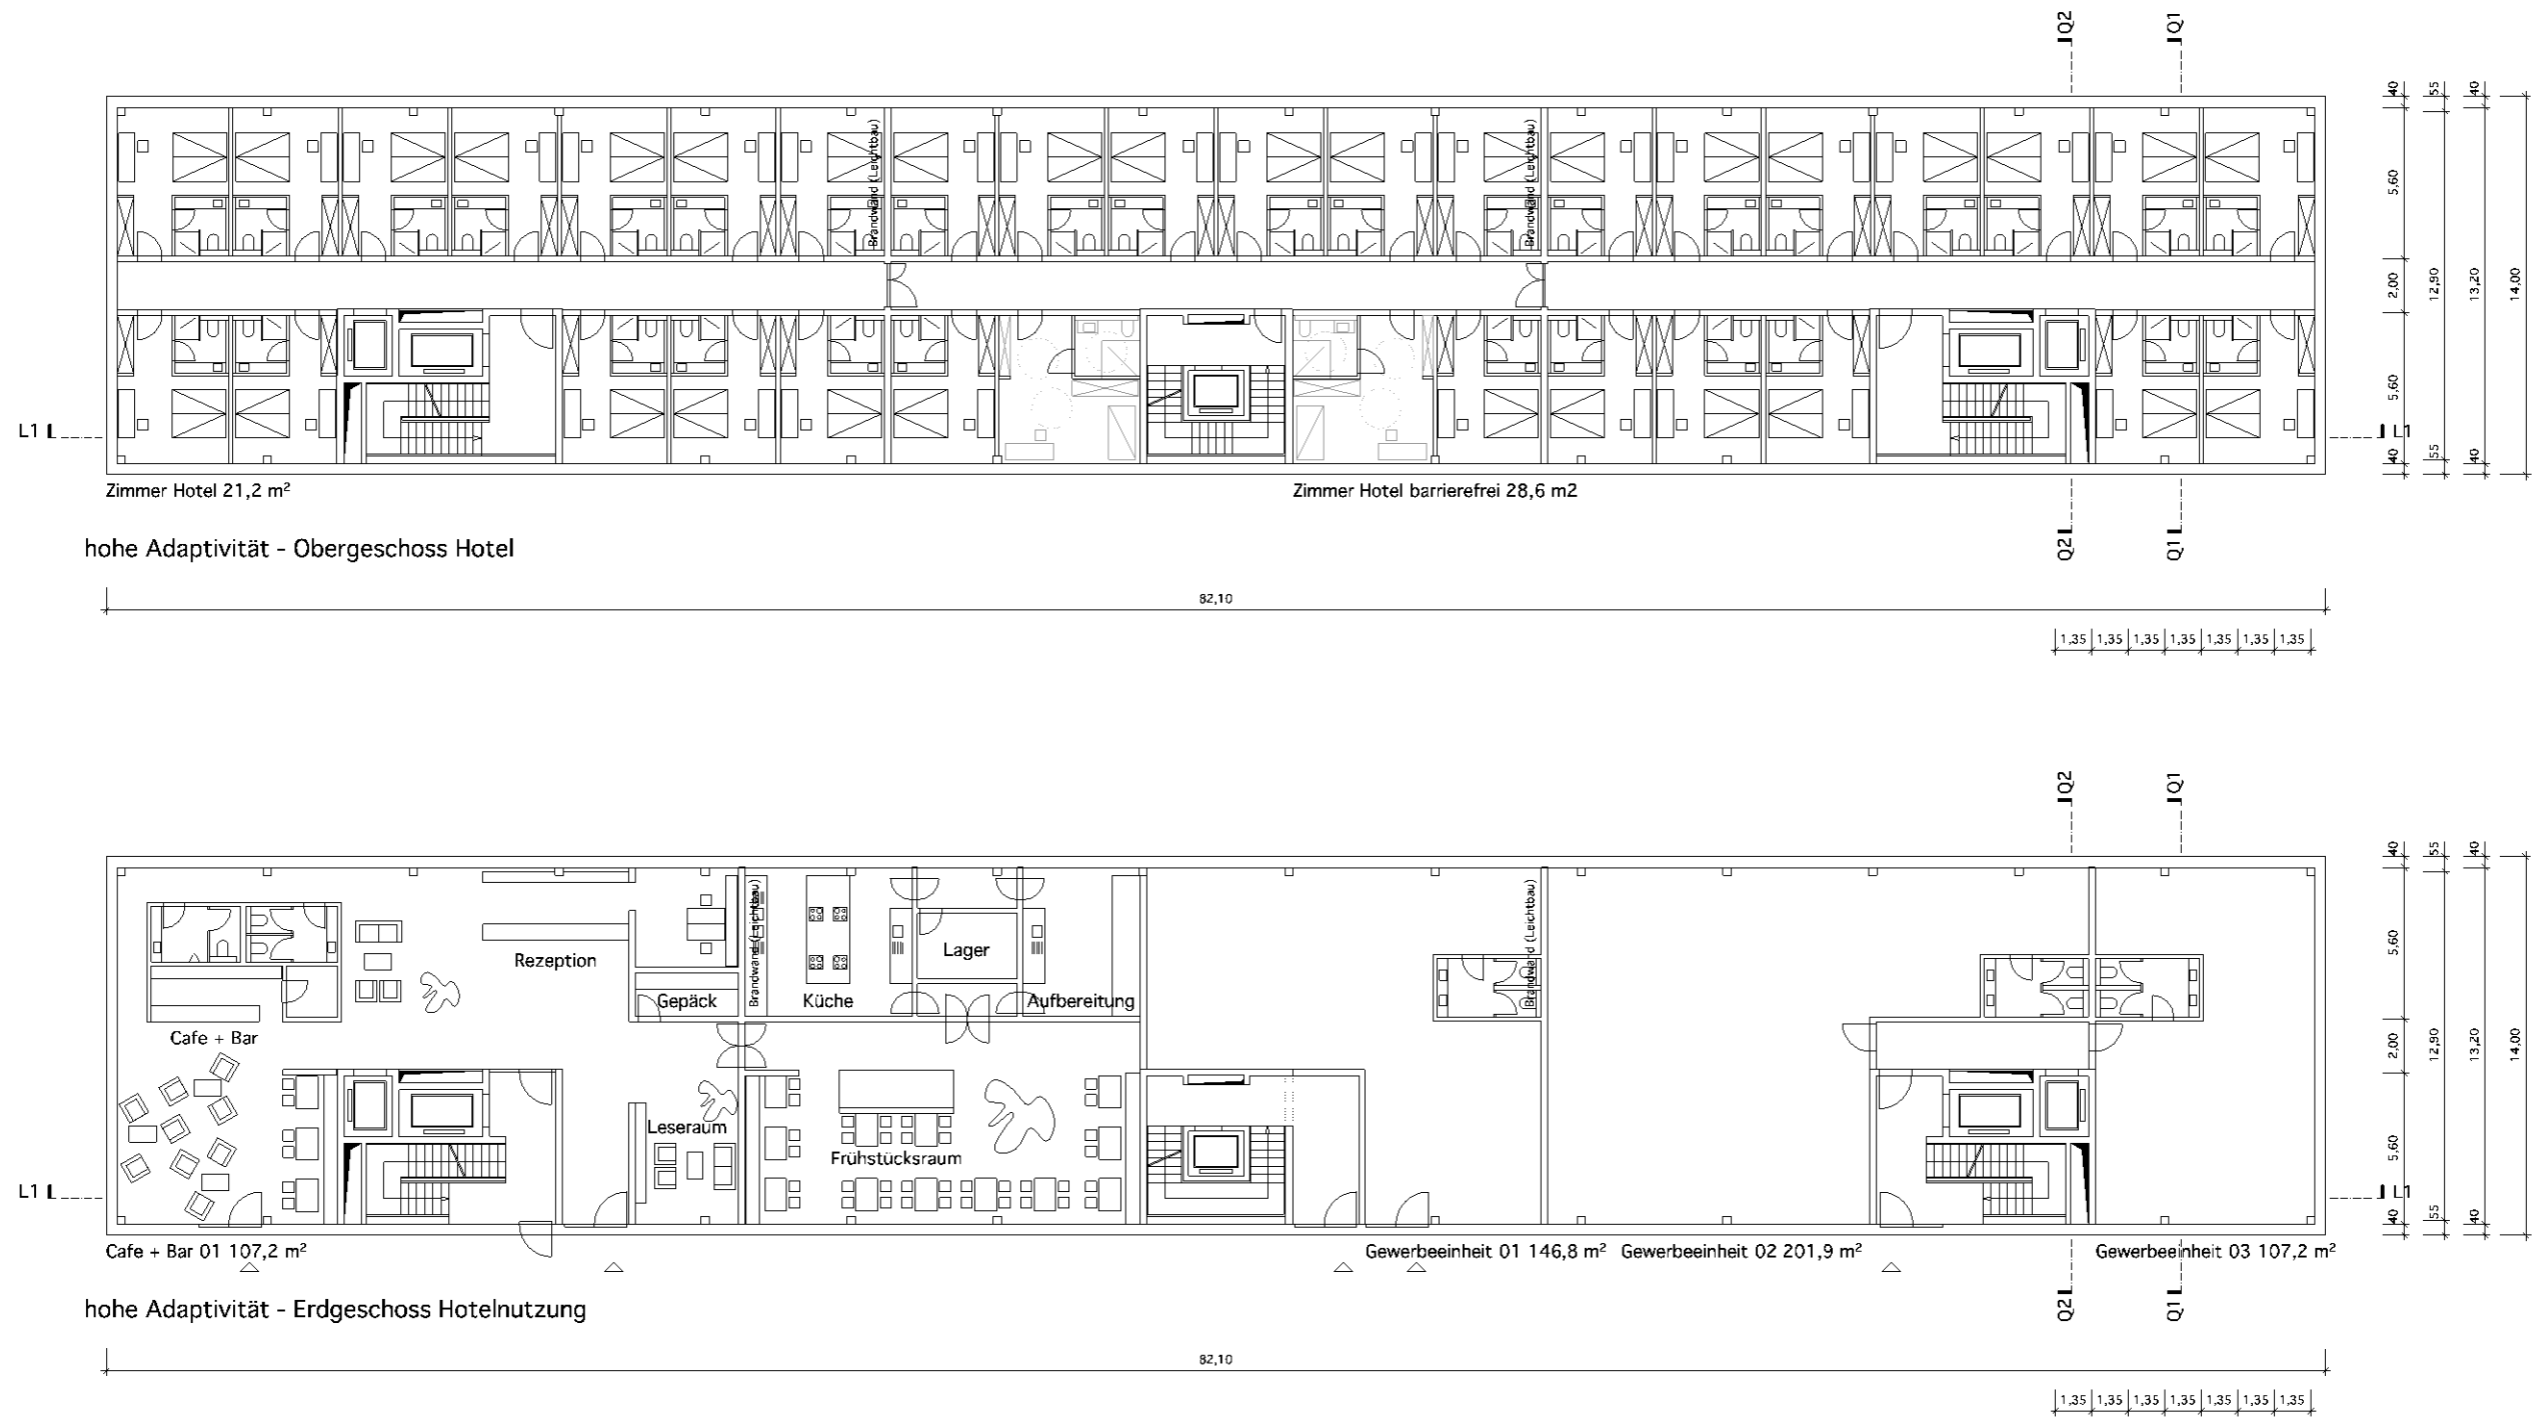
Grundrisse Obergeschoss (oben) und Erdgeschoss (unten) des Referenzgebäudes „hohe Adaptivität“ für eine Hotelnutzung
